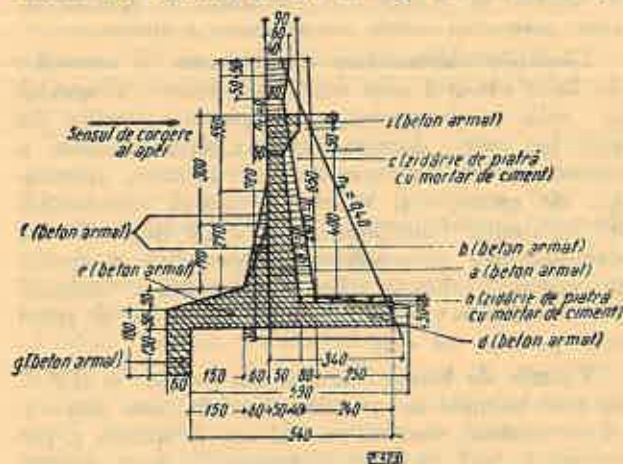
Secțiune transversală prin barajul din plăci de beton armat în consolă, executat în perimetrul de ameliorare Doftana II:
